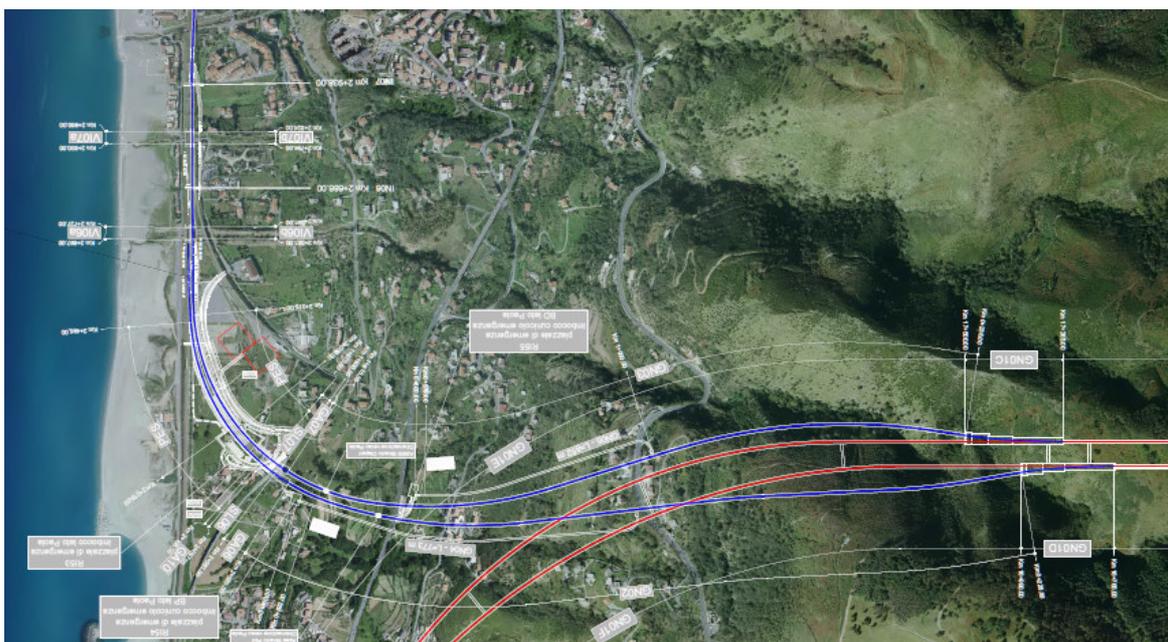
Stralcio planimetria su ortofoto delle interconnessioni verso Paola,
